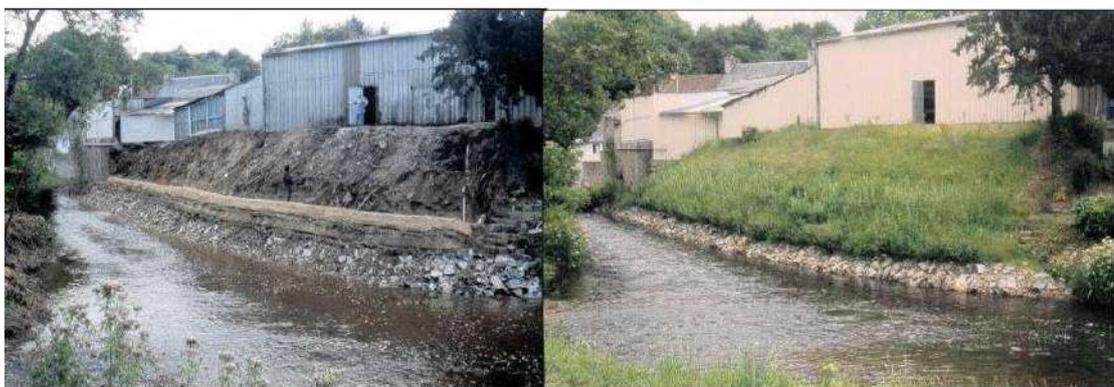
Exemple de chantier de restauration et stabilisation de berges au moyen de techniques mixtes : empierrement sous-fluvial et lits de plants et plançons renforcés par des boudins de géotextile. Etat de l'ouvrage en cours de chantier puis six mois après l'achèvement des travaux.
